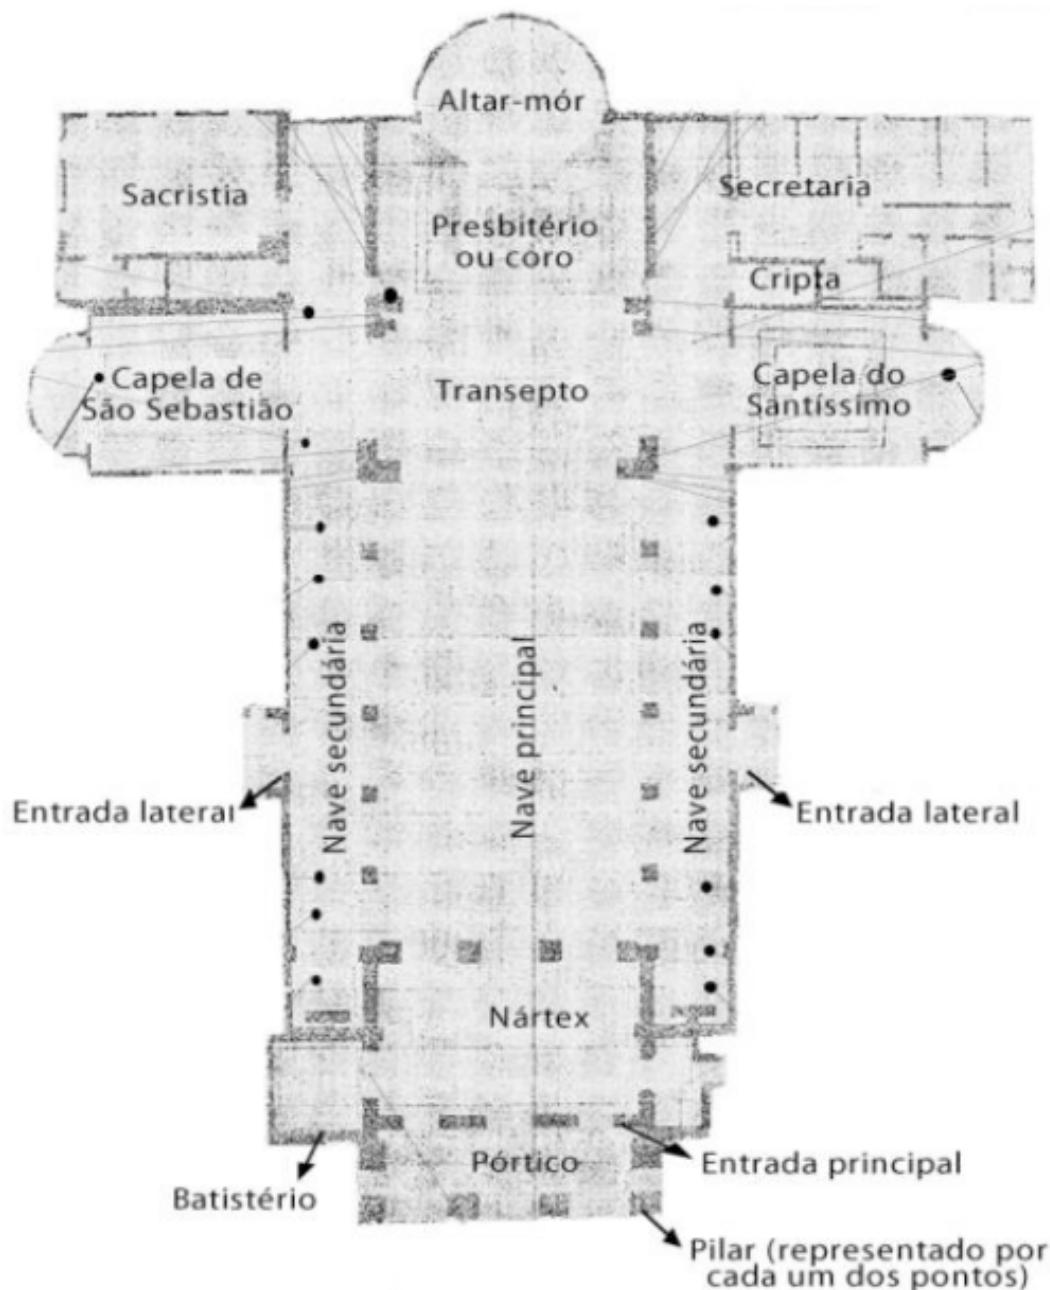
Planta Baixa da Catedral. Fonte: Projeto de Solicitação de Restauo, s/d.
